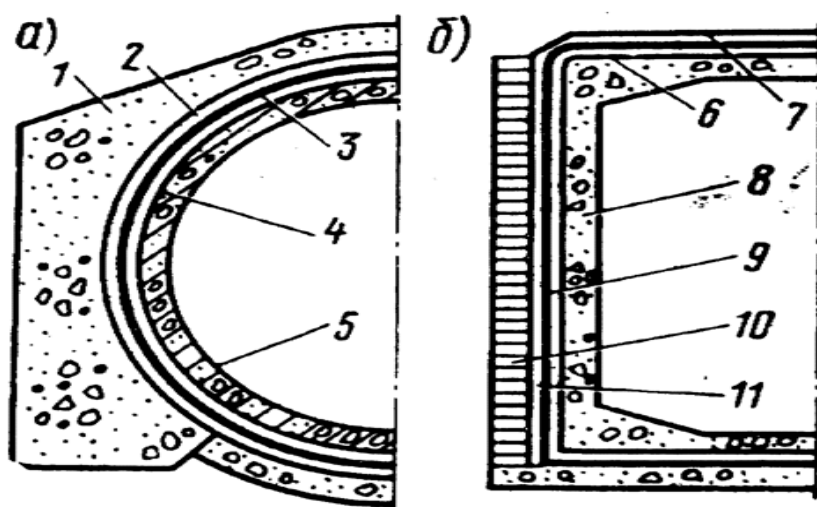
Схема устройства оклеечной гидроизоляции: а – внутренней; б – наружной
